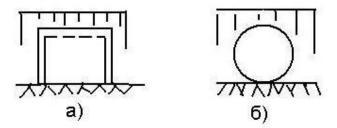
Трубы в насыпи прямоугольного очертания больше деформируются, чем круглые
